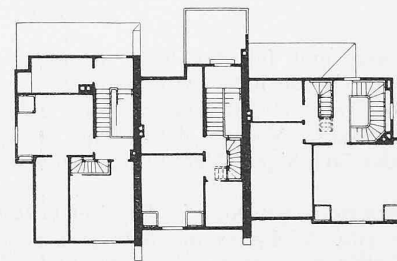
Grundriss vom Kellergeschoss.
